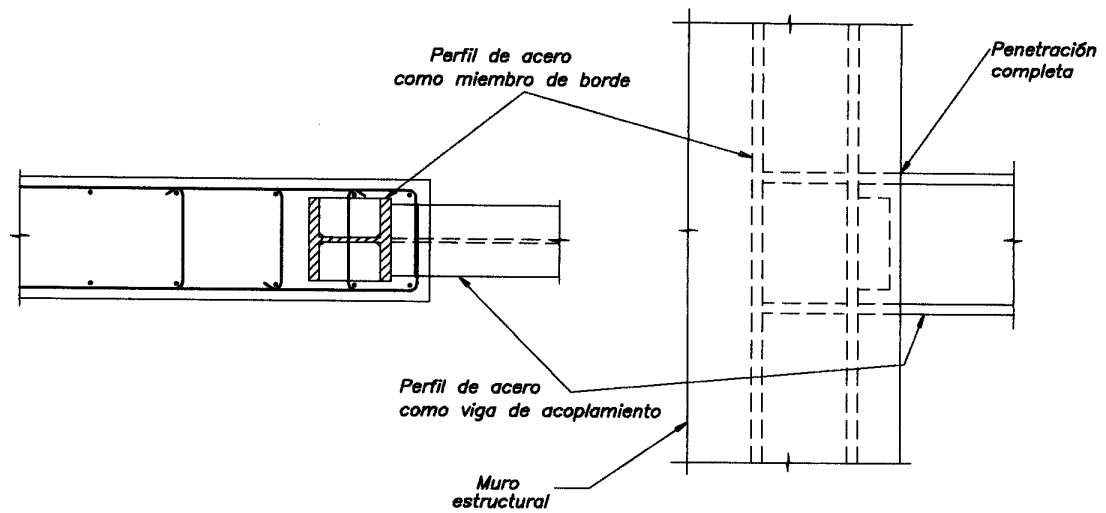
EJEMPLOS DE MUROS DE SECCIÓN MIXTA ACERO - CONCRETO
